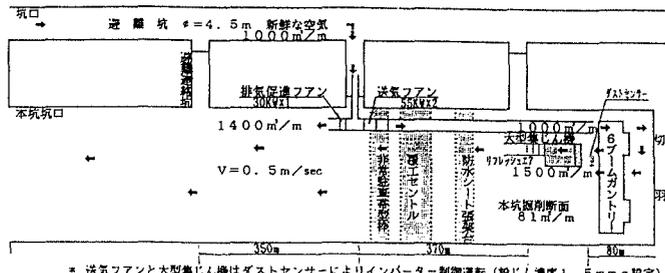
スーパークリーントンネリングベンチレーションシステム概要平面図
